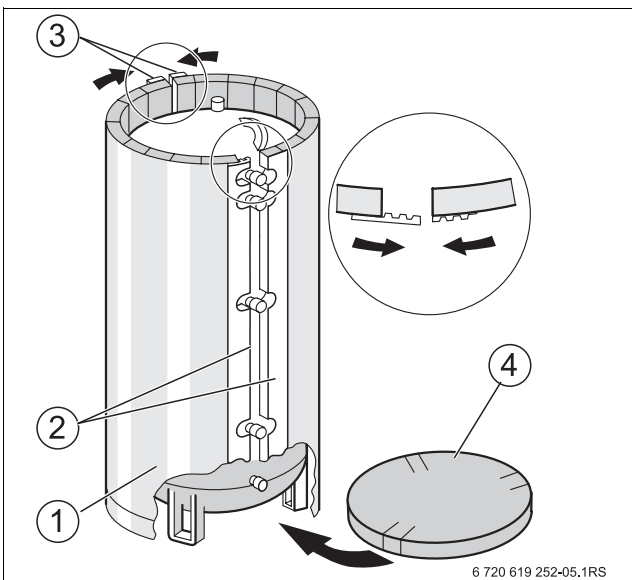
Wärmedämmung montieren (Ansicht von hinten)
